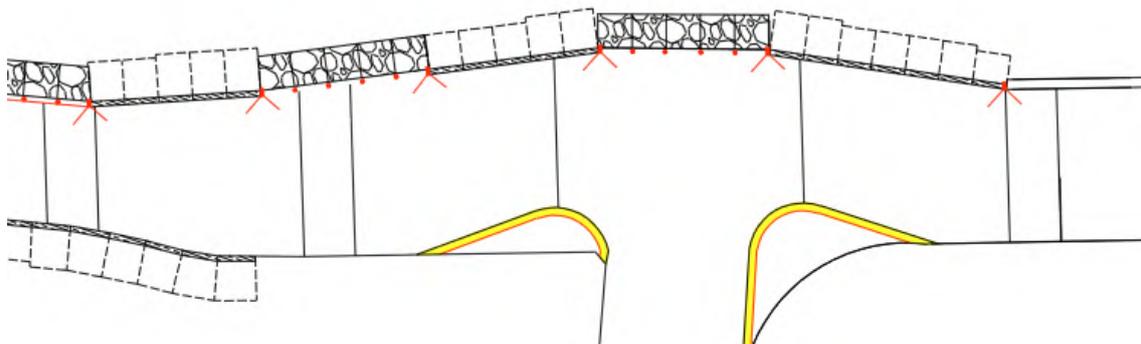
Verbreiterung der Unterführung - Planskizze
